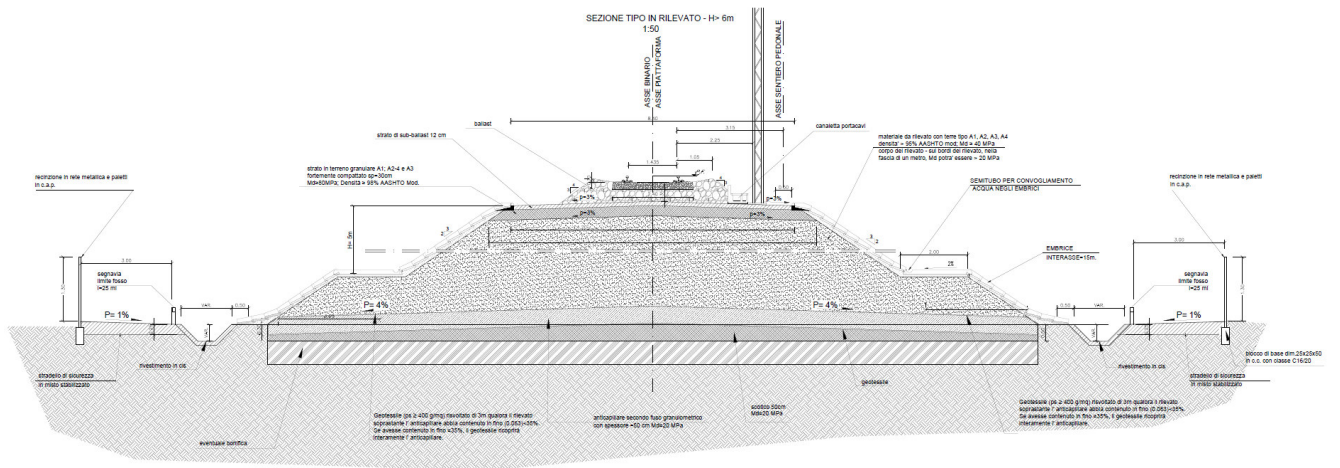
Sezione tipo in rilevato a SB, $H > 5.0$ m
